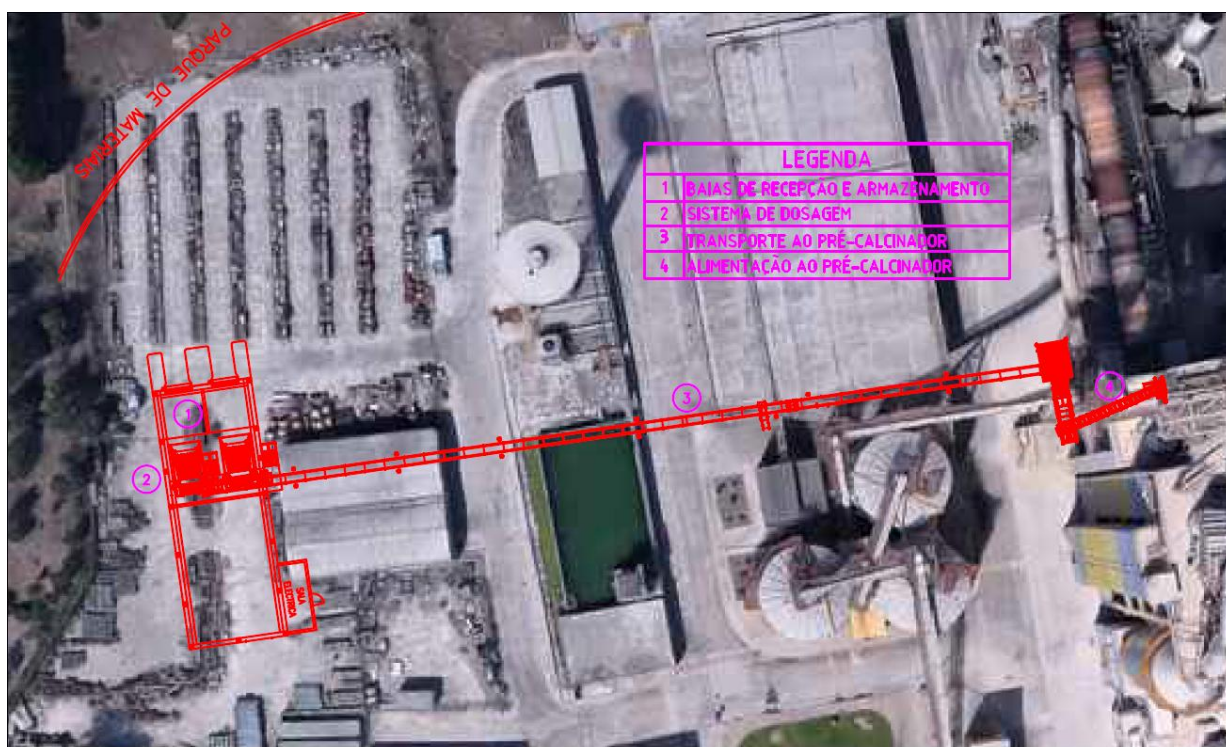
Localização prevista (em imagem aérea atual) para a instalação CA5 e layout.
